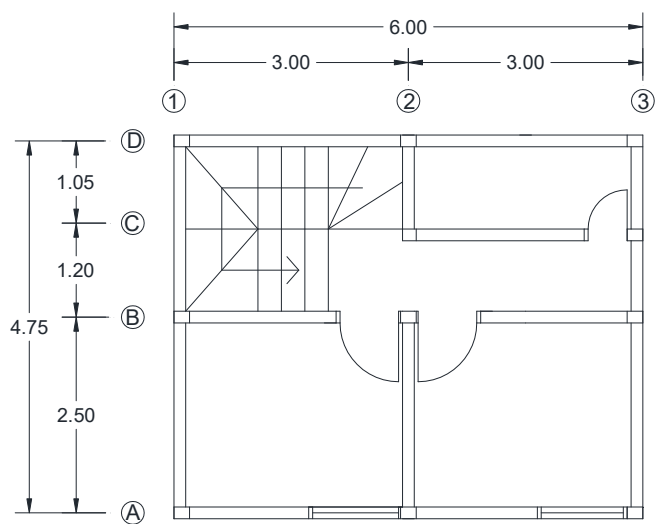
Denah rumah tinggal tipe 56 lantai 1
